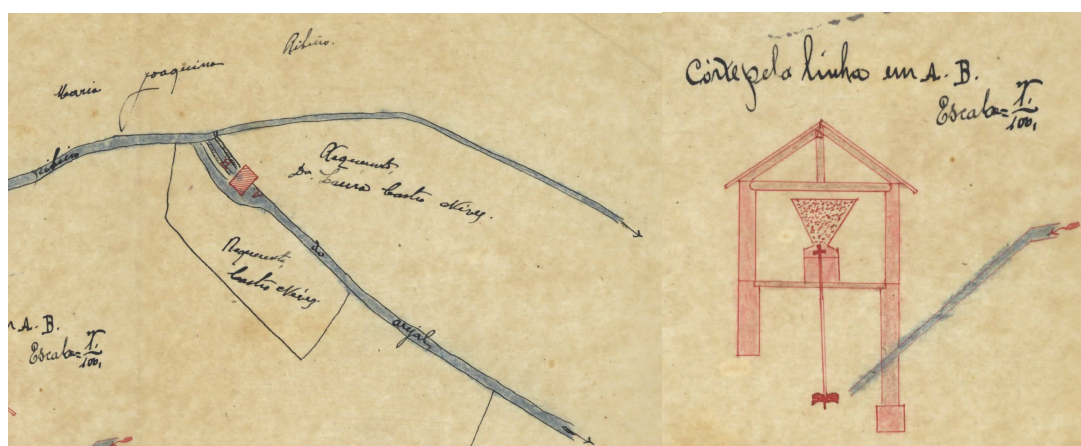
Planta e corte e entregues no requerimento de Laura Castro Neves. Fonte: APA.
